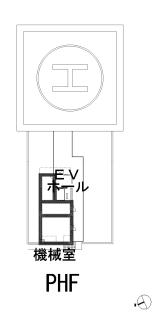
病院本館建築平面図 (ヘリポート)
